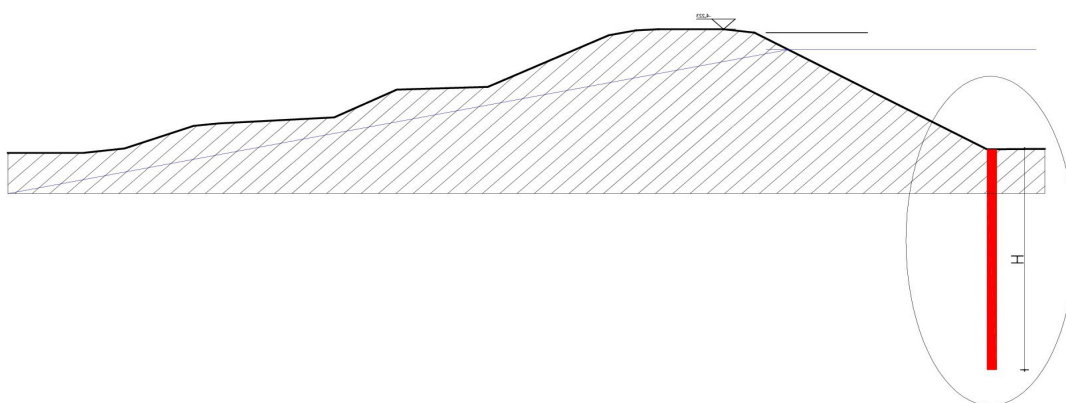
sezione tipo di progetto del diaframma con sistemazione della sommità
